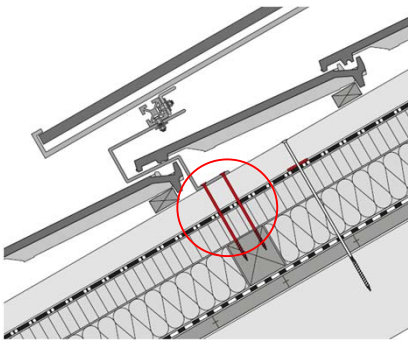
Die Schrauben der Dachhaken durchdringen das Unterdach. Diese Durchdringungen müssen mit Nagelbändern/Nageldichtungen abgedichtet werden.
